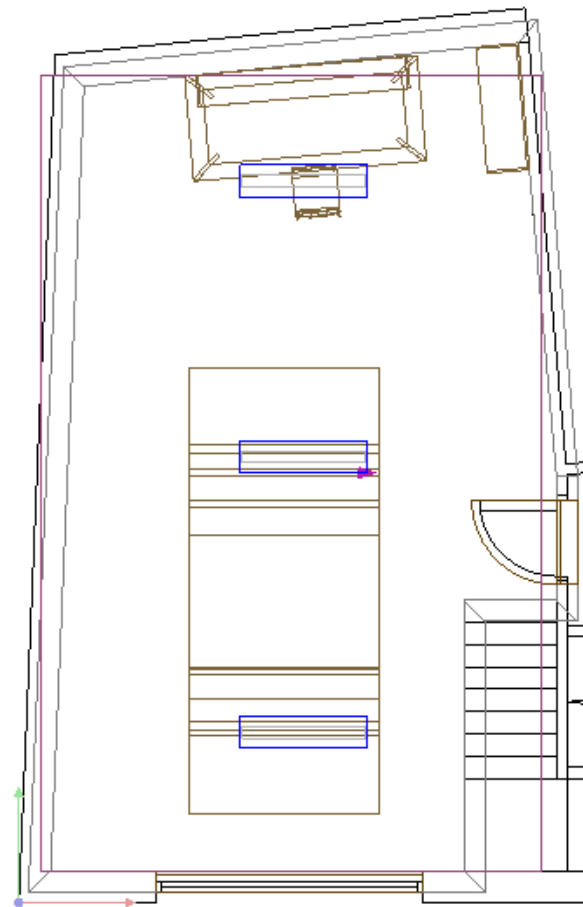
Plano del aparcamiento de la vivienda unifamiliar.
